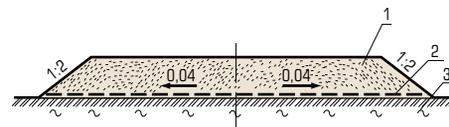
Конструкция насыпи на участках переувлажненных грунтов: 1 — песчаный грунт; 2 — прослойка из НСМ; 3 — переувлажненный грунт
